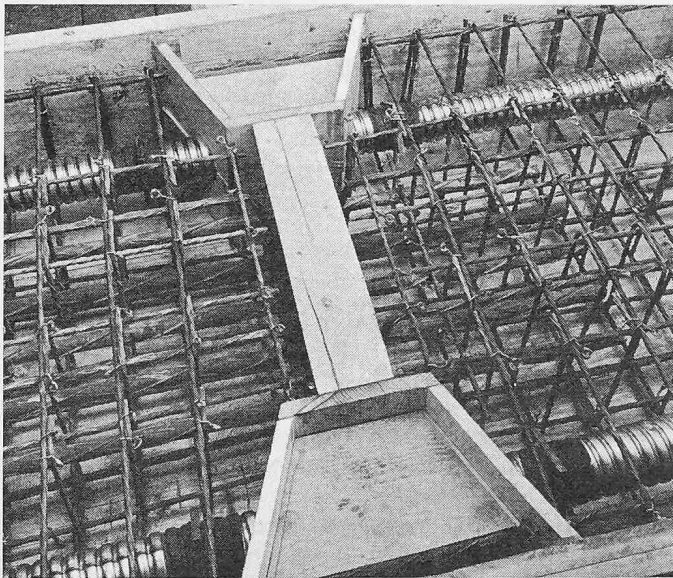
Detail zu Bild 6, Gelenkarmierung 5 Ø 24
